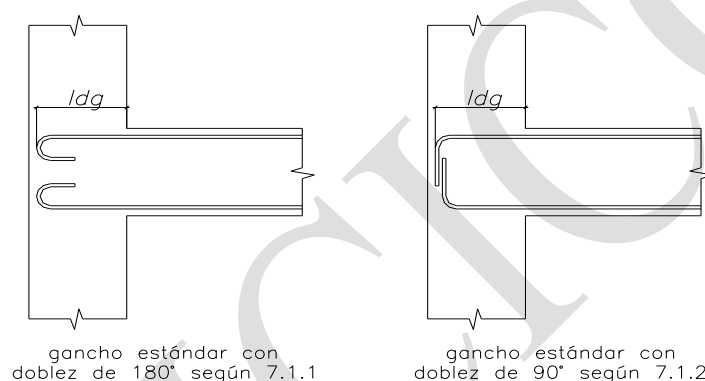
Longitud de anclaje con gancho estándar en tracción.
